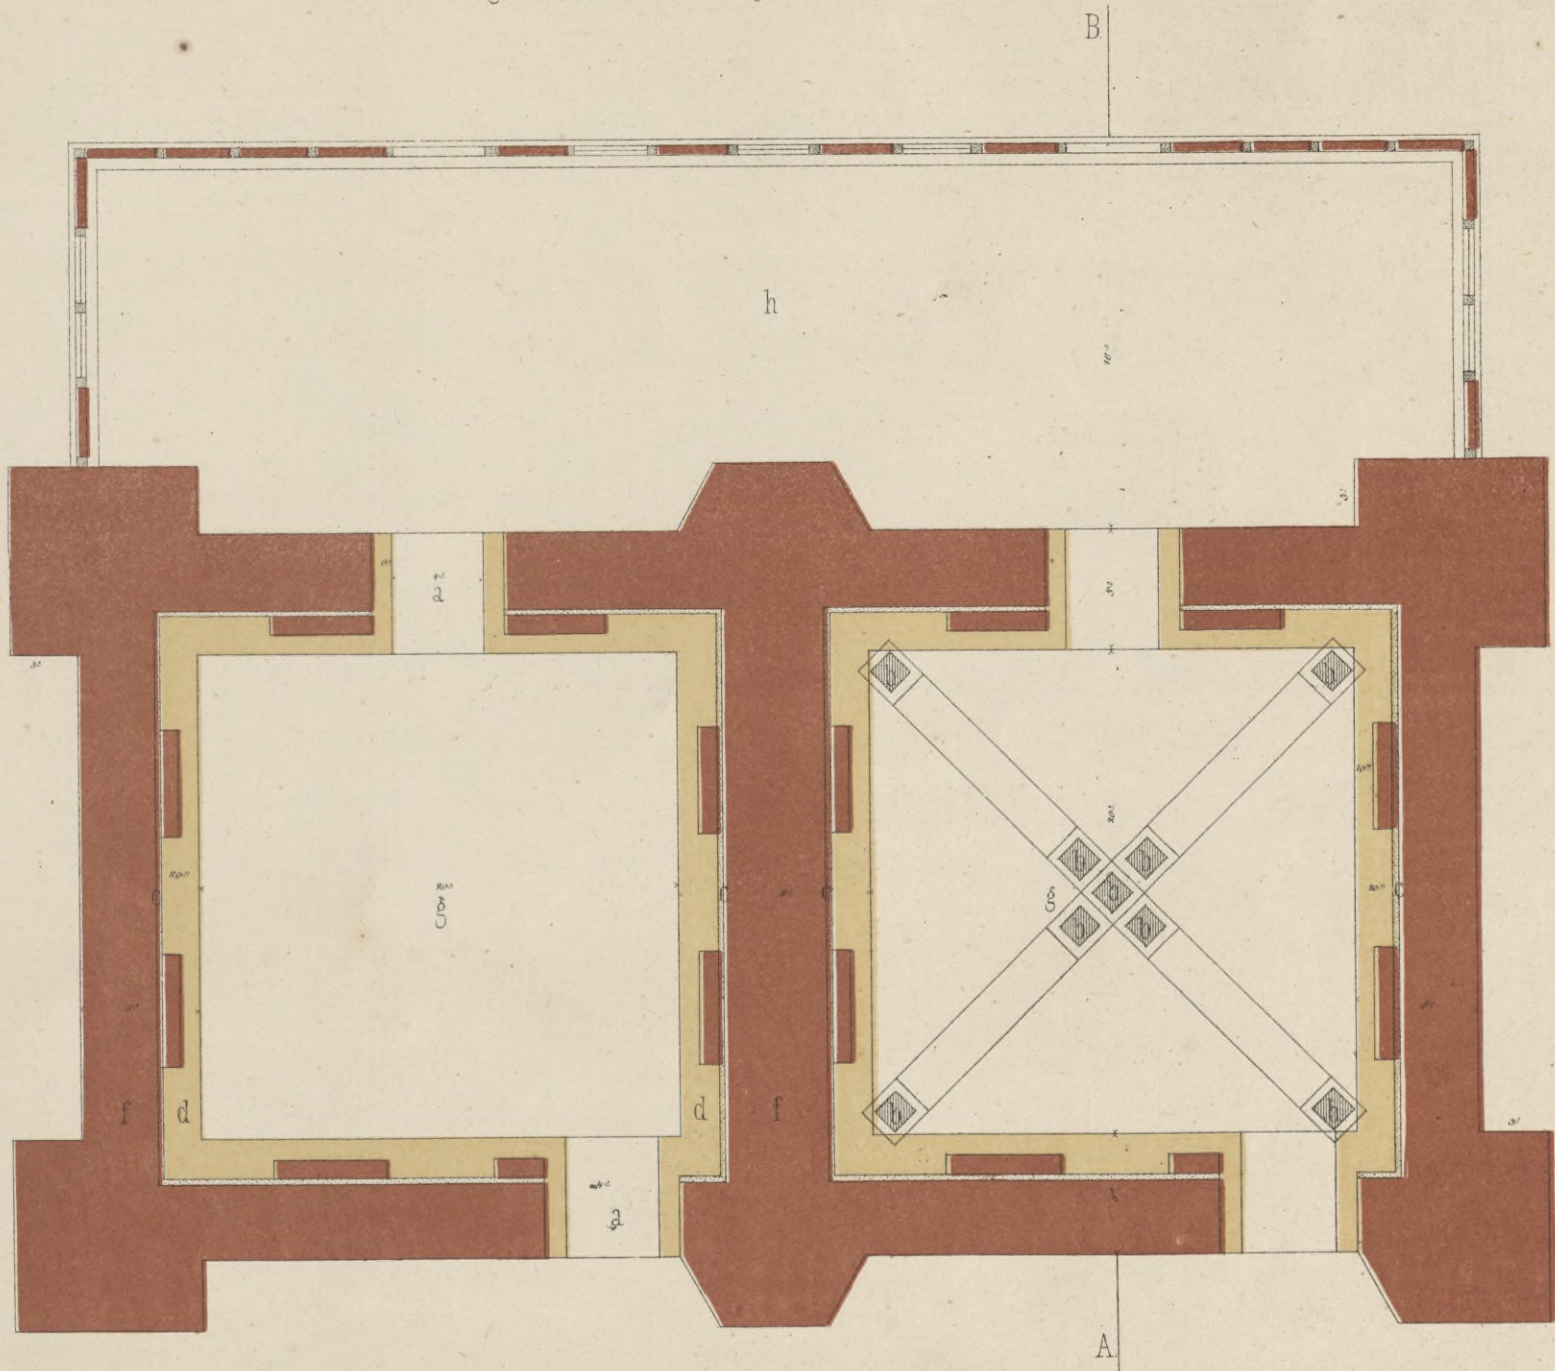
Grundriss mit Angabe der fünf Rauchkanäle.
